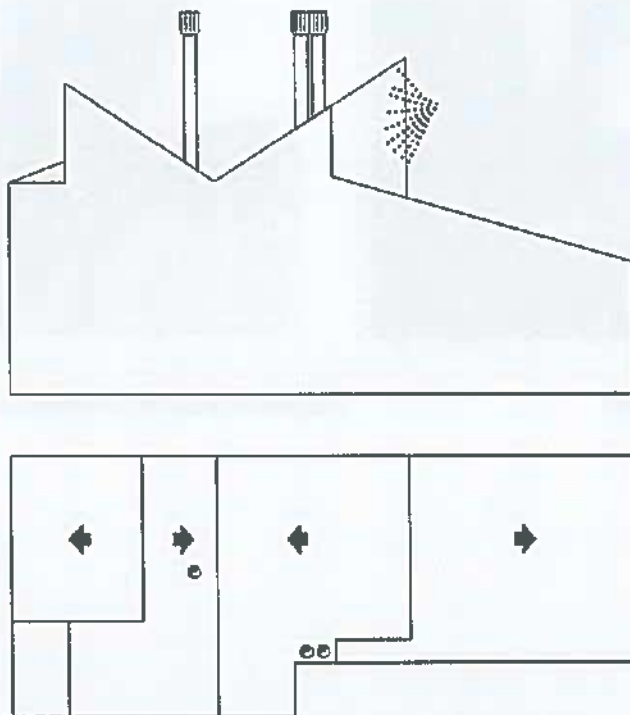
Esquema de cubiertas de la vivienda. Punto singular probado en fachada baño
